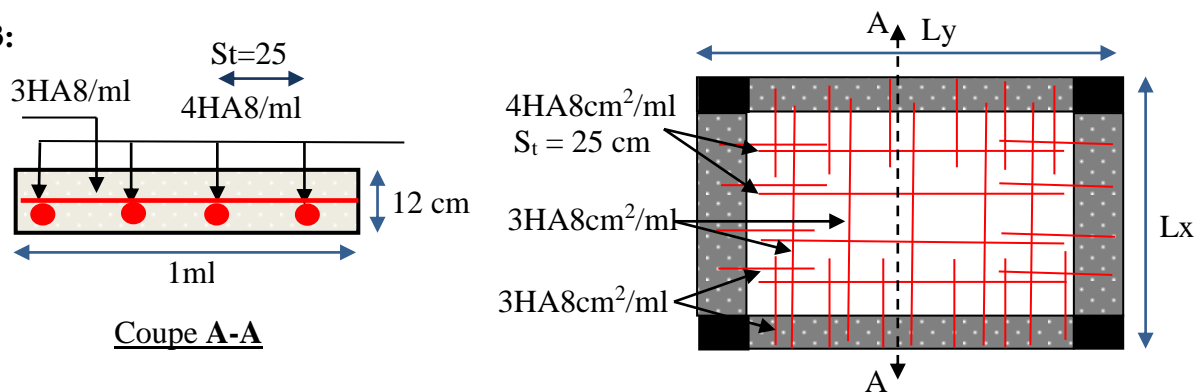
ferrailage de la dalle sur 4 appuis (étage courant).
